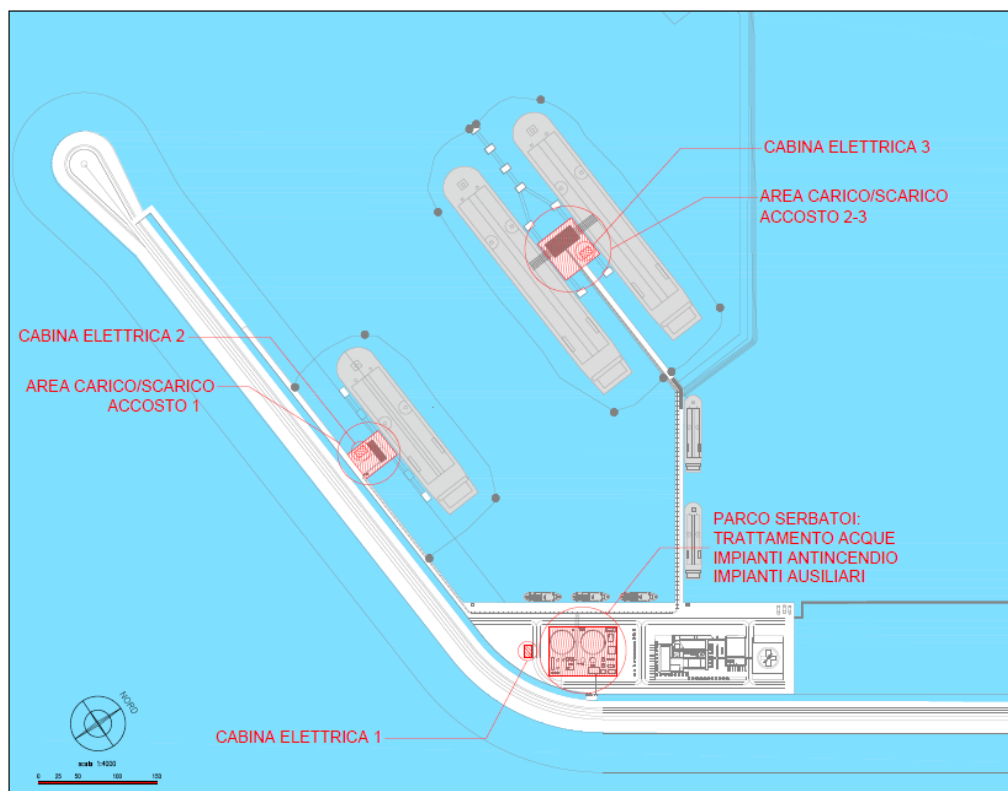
planimetria disposizione impianti – terminal petrolifero
